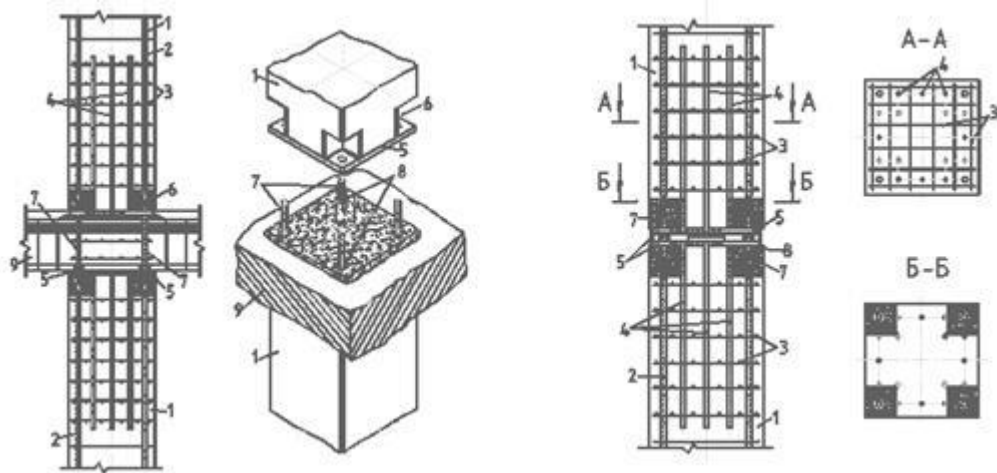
Конструкція гвинтових з'єднань збірних з/б колон. 1- збірна з/б колона; 2- поздовжня робоча арматура; 3- арматурні сітки; 4- анкрні стержні; 5- торцеві сталеві лити; 6- кутові ніші; 7- з'єднувальні шпильки; 8- гайки; 9- диск перекриття.
